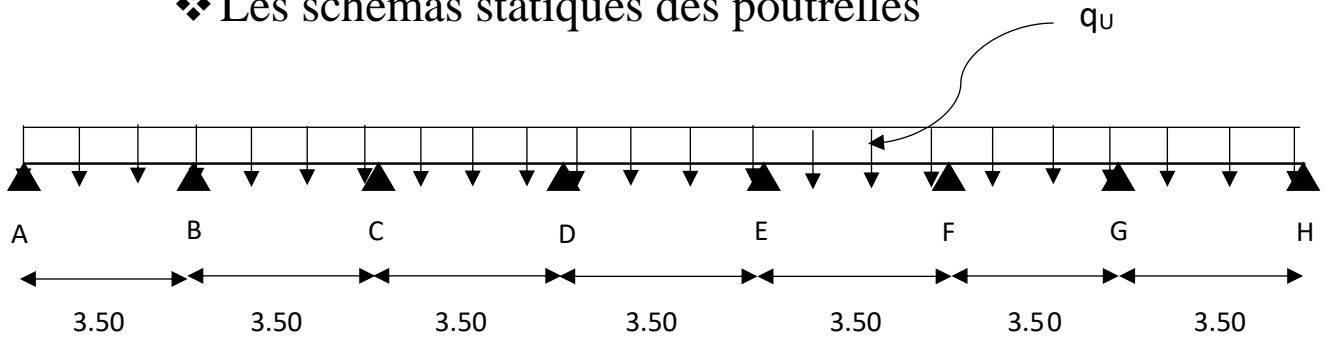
Schéma statique de la poutre continue reposant sur huit appuis.
